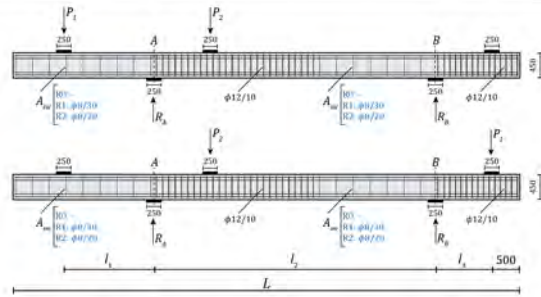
Detalle de la geometría y la armadura transversal: (a) ensayo de voladizo (CE); (b) ensayo de vano (SE). (Cotas en mm).
